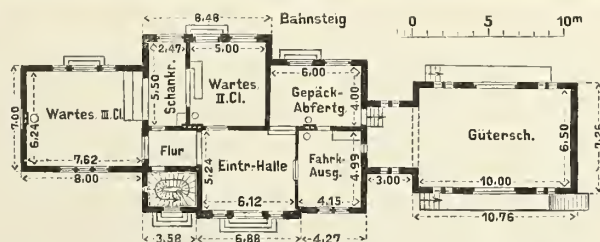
Stationsgebäude in Hadersleben. Erdgeschoss.
